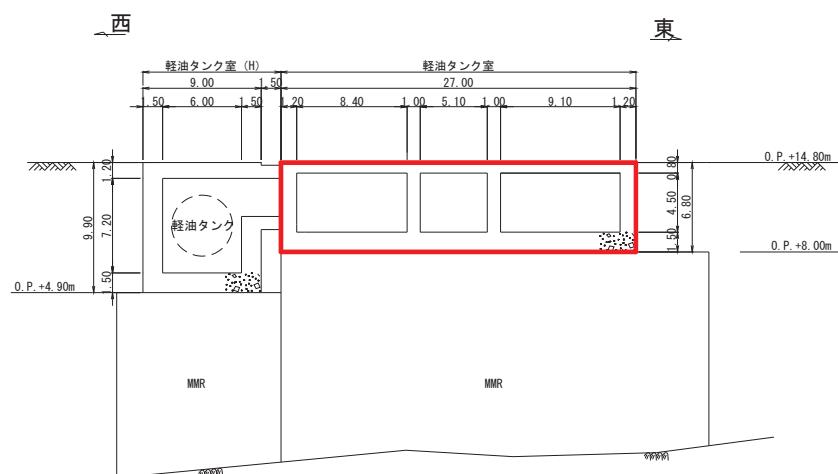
軽油タンク室断面図 (C-C, ポンプ室)
